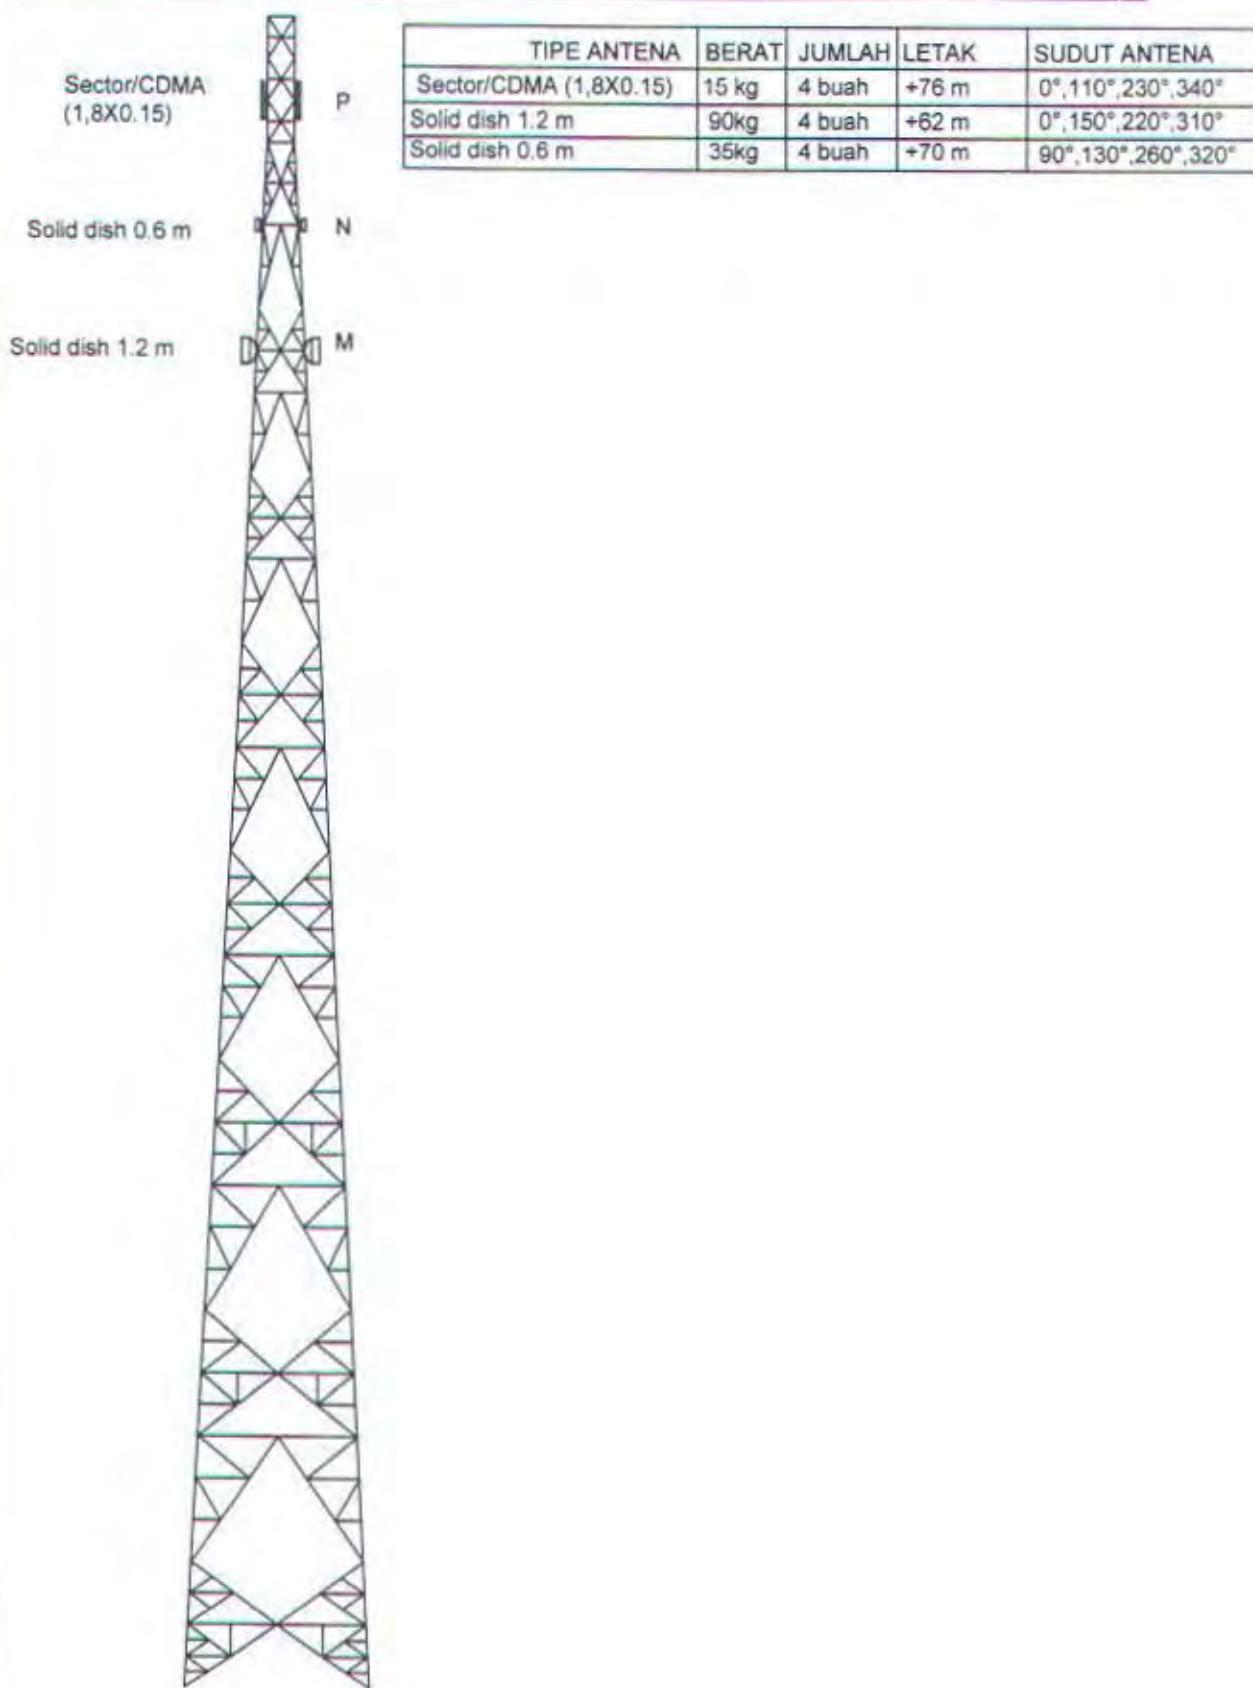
Pembebatan angin tampak samping tower alternatif 1
